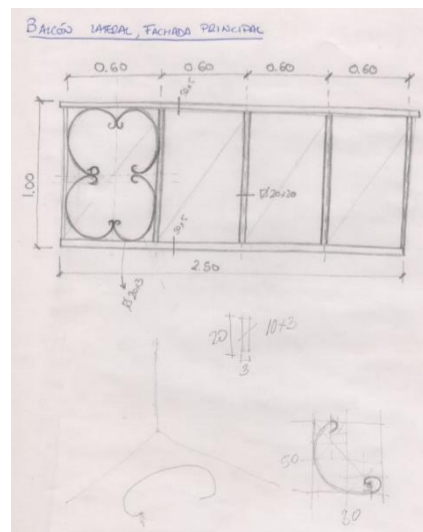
Balcón y detalles croquizados. Fuente: Elaboración propia
